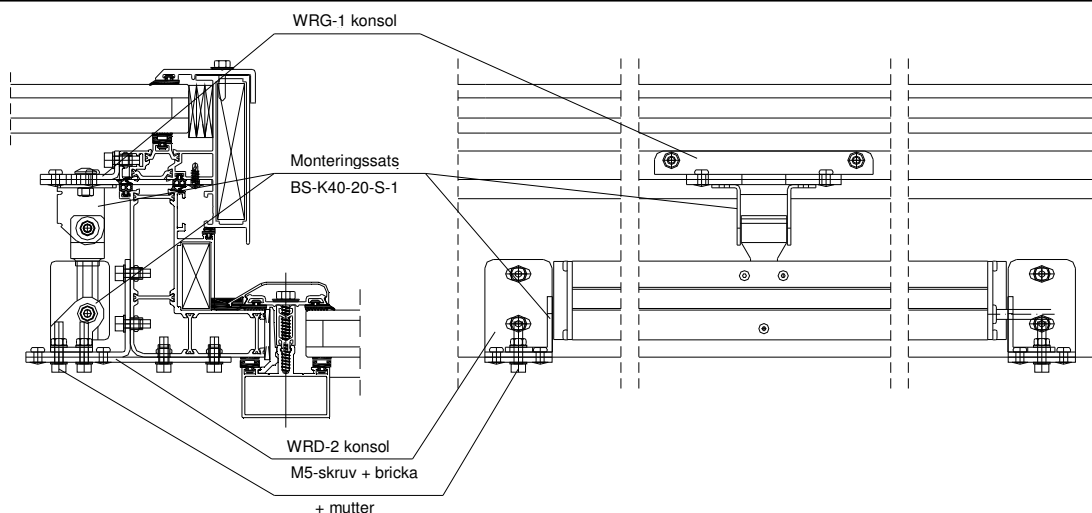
Montering av MCR-L KR10B kedjemotorer i takfönster
